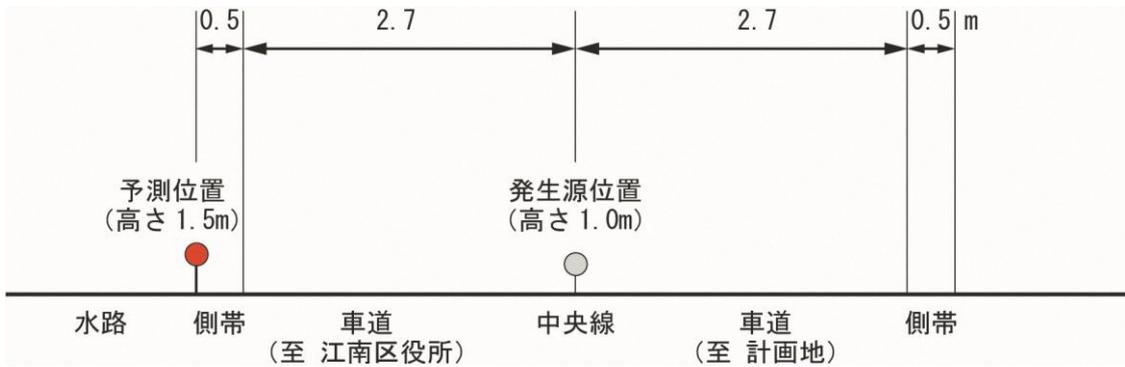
(4) 道路断面図 (No. 4 : 新施設西側沿道)
